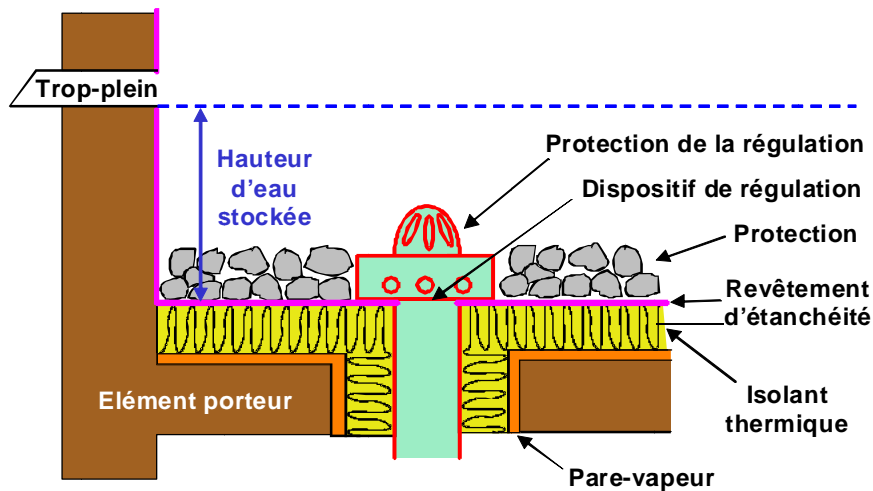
Principe de conception d'une toiture stockante (Source : OIEau)
